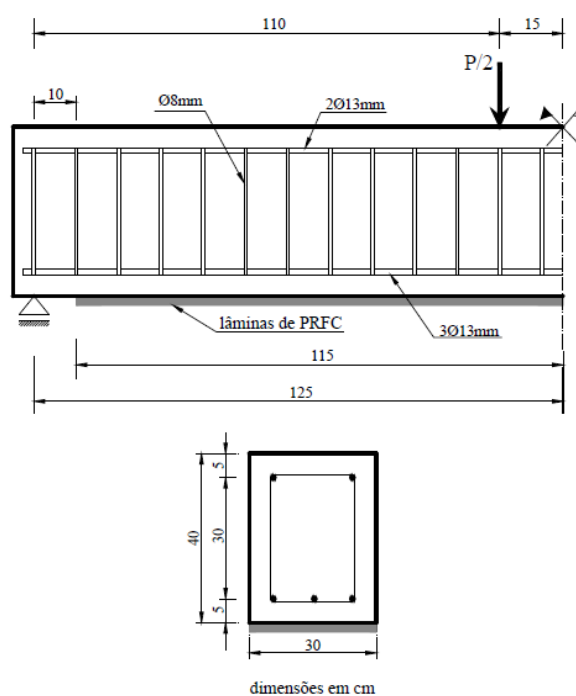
Detalhamento das vigas ensaiadas por Arduini et al. [7].
